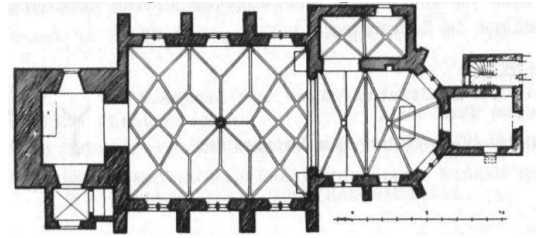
Remagen, St. Peter und Paul, Grundriss
